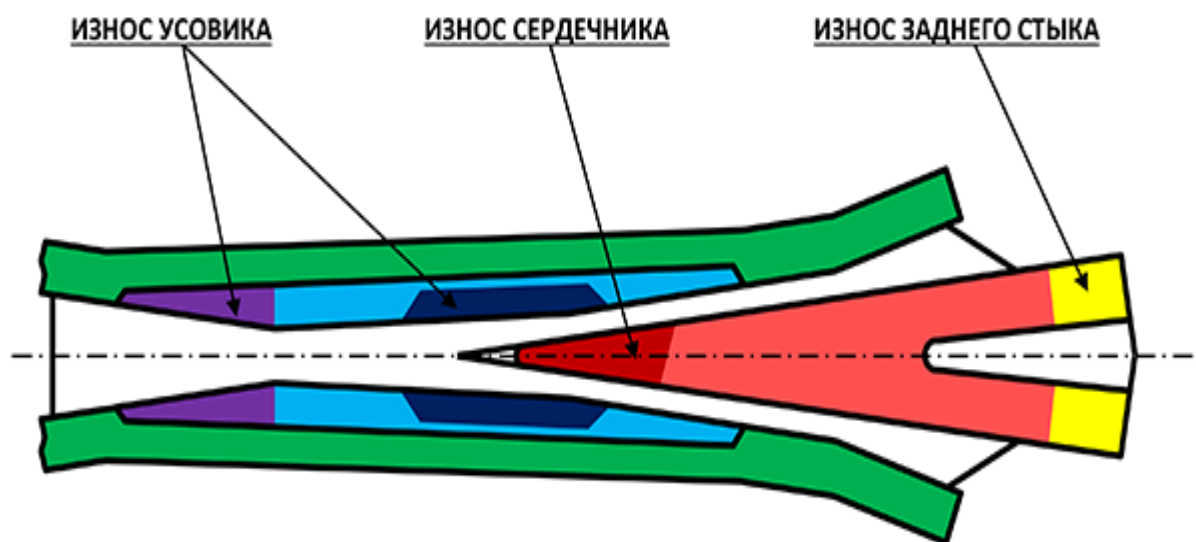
Схема наплавки крестовин с использованием наплавочного комплекса TANSLAMATIC [25]
